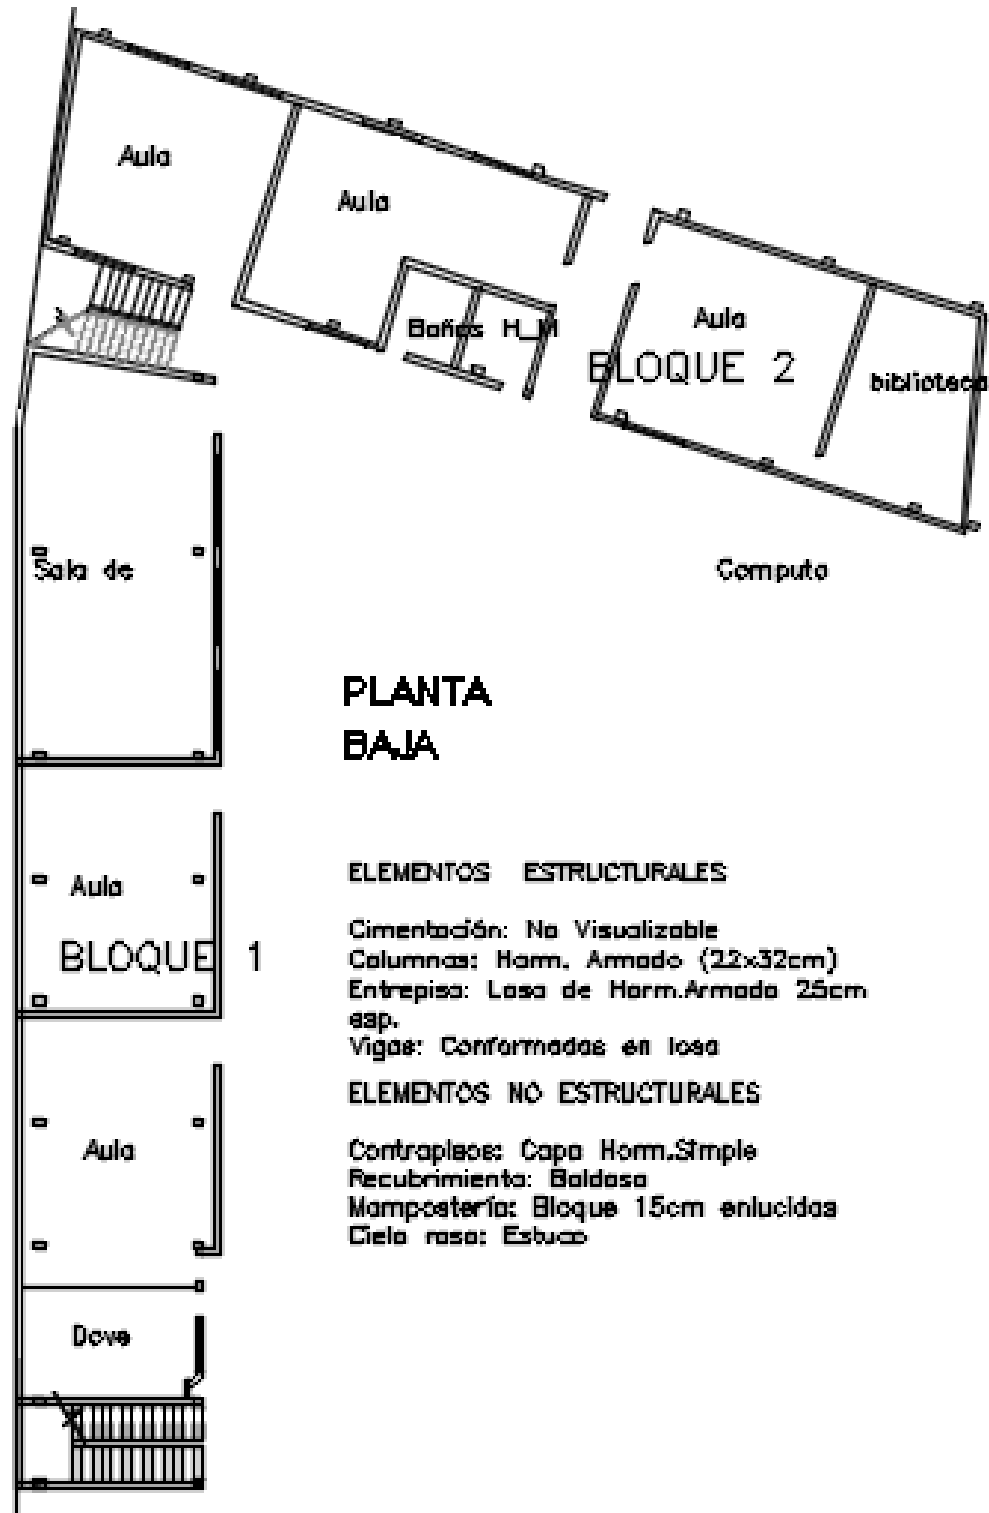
Levantamiento planimétrico de la Planta Baja de la Unidad Educativa “Nuestra Familia”
